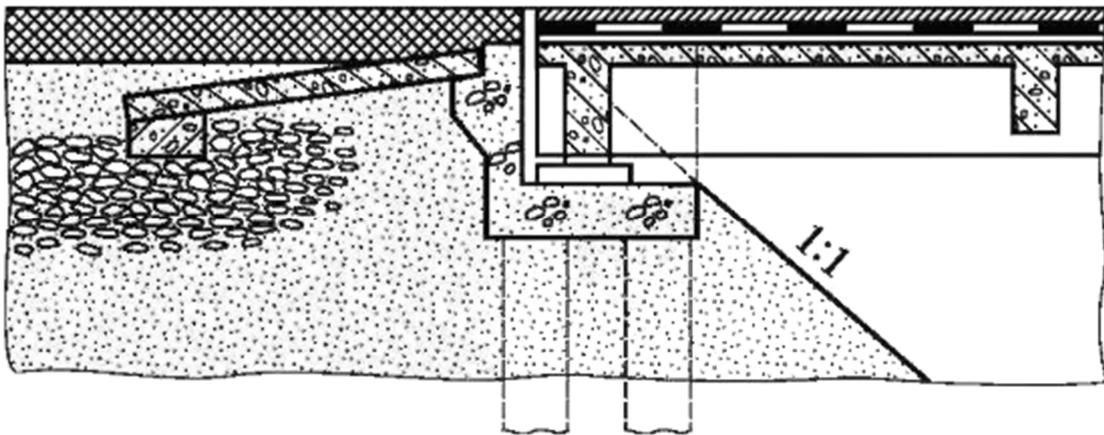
Конструкція перекриття торців пролітних будівель
